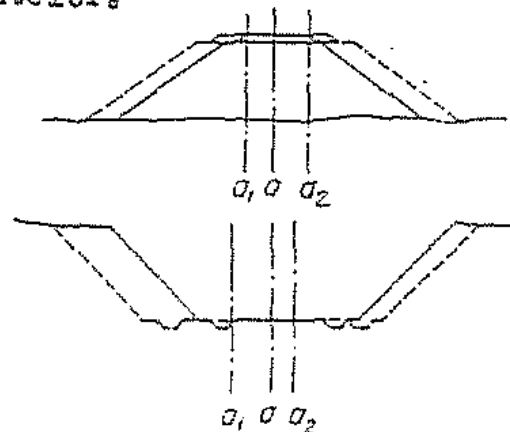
Profil transversal în zona de trecere dintr-o parte în alta a liniei existente
